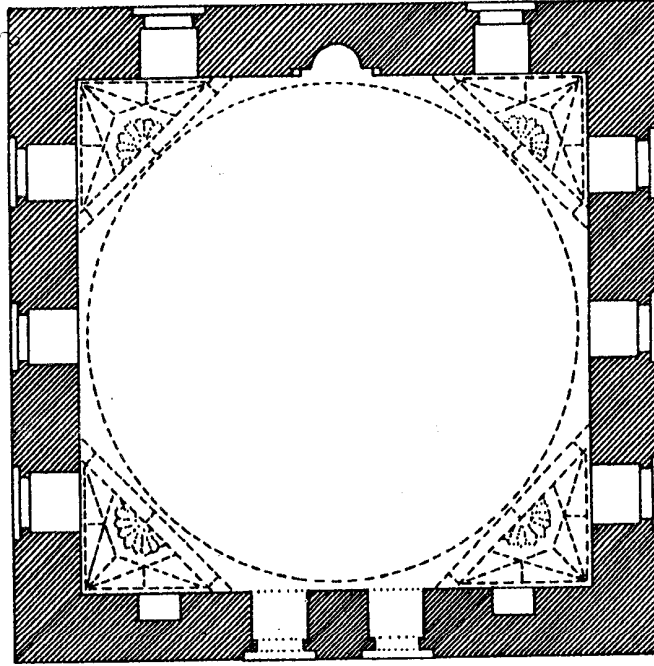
مسقط أفقي لمسجد جولدي
